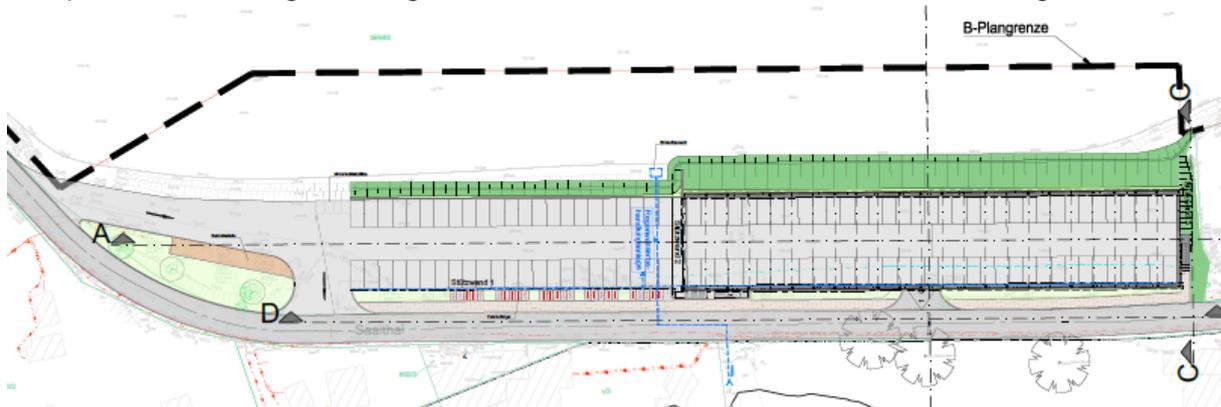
Lageplan Parkdeck (Steinbacher-Consult GmbH)
